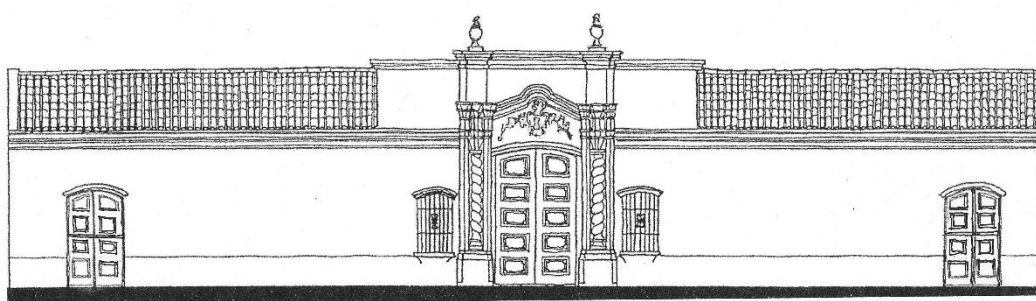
Reconstrucción de la fachada de la Casa Laguna Bazán. Elaboración propia
